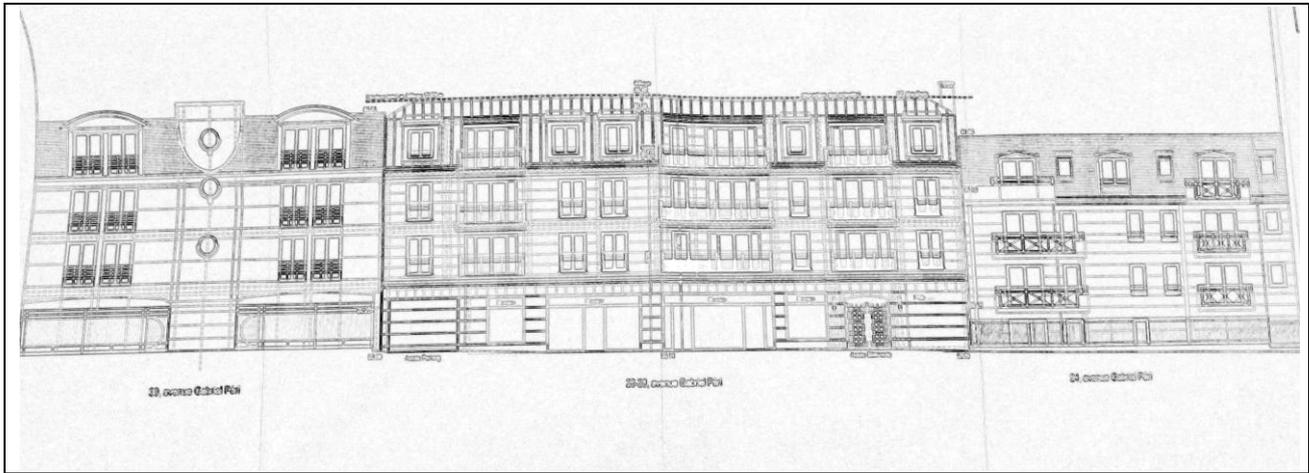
façade du projet Franco Suisse pour les n° 26, 28 avenue G. Péri
